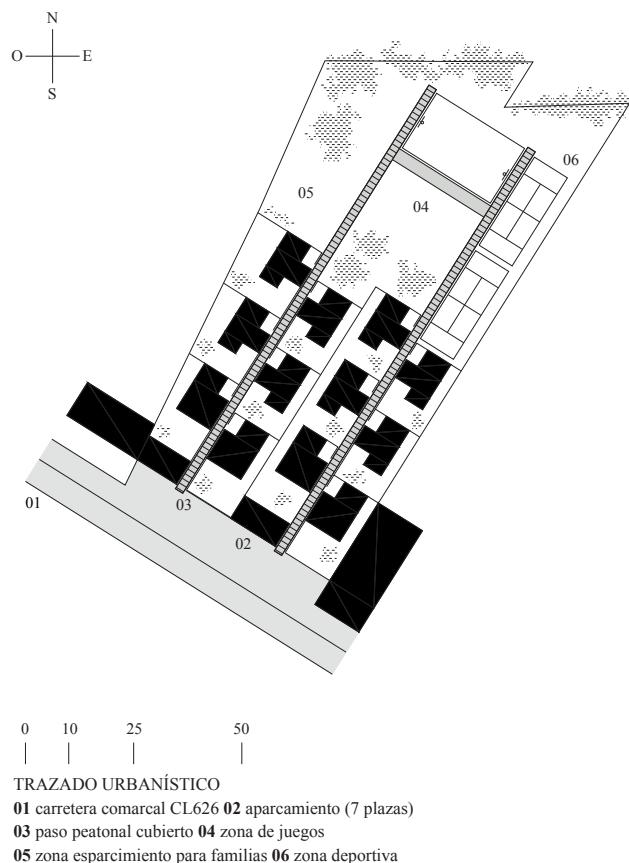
Poblado de Aguilar de Campoo (1962-64). Trazado urbanístico.
